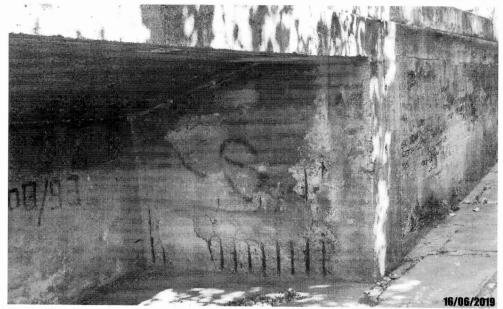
Detalhe de armadura exposta e desplacamento de concreto no muro ala.
